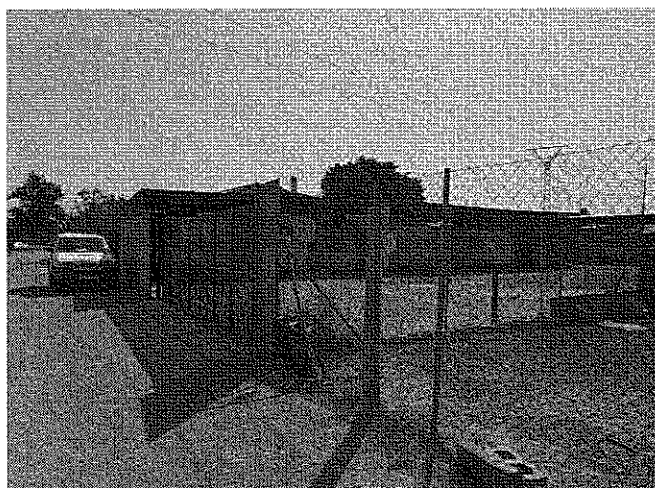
Vista de la zona de aparcamiento de caravanas en su acceso por el interior de la parcela (lindero Oeste).
